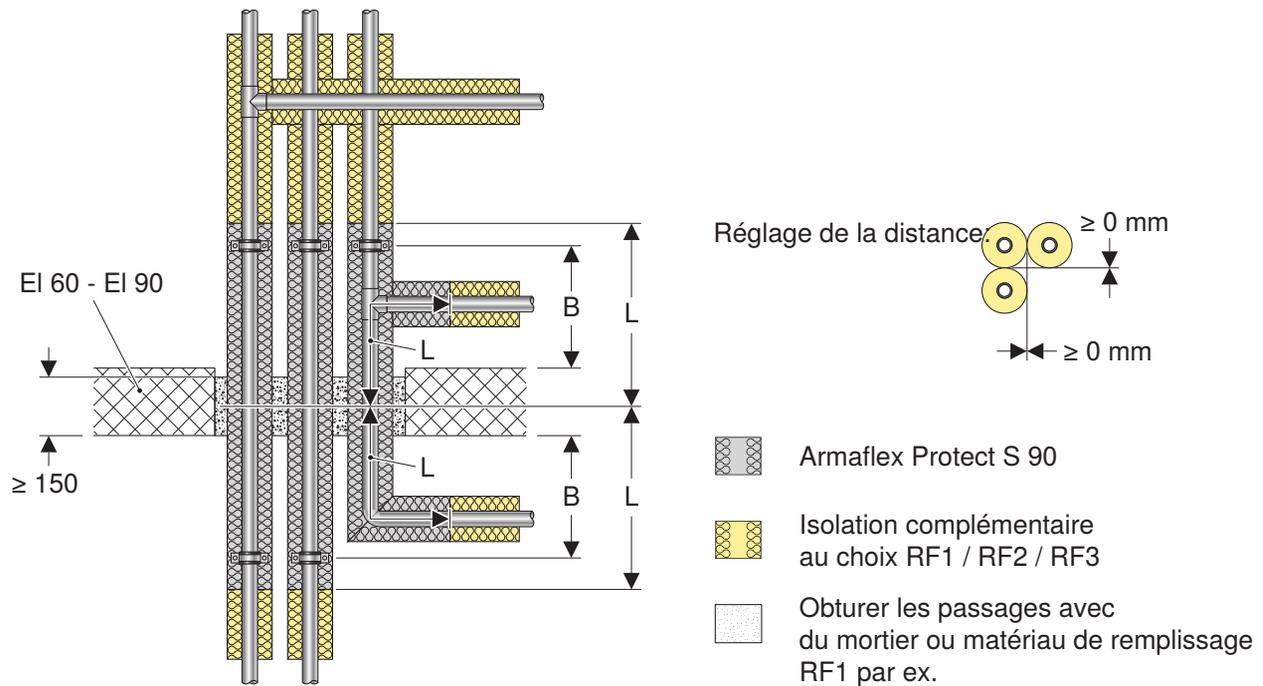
Traversée de dalle supérieure avec isolation Armaflex Protect
